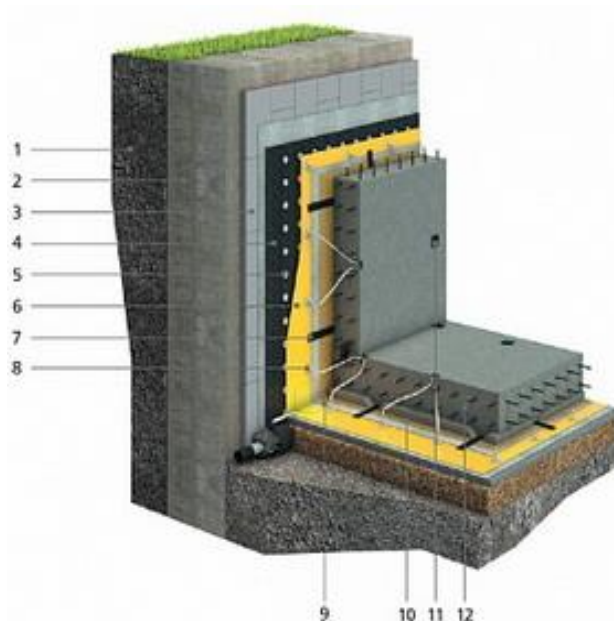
Система гидроизоляции тоннелей, возводимых способом "стена в грунте": 1 – грунт; 2 – стена в грунте; 3 – экструзионный пенополистирол; 4 – защитно-дренажный слой; 5 – крепежный элемент – ПВХ рондель; 6 – полимерная мембрана; 7 – ПВХ гидрошпонка; 8 – ПВХ инъекционный штуцер; 9 – защитный слой – геотекстиль; 10 – полиэтиленовая пленка; 11 – проверочный люк; 12 – внутренняя армированная конструкция
